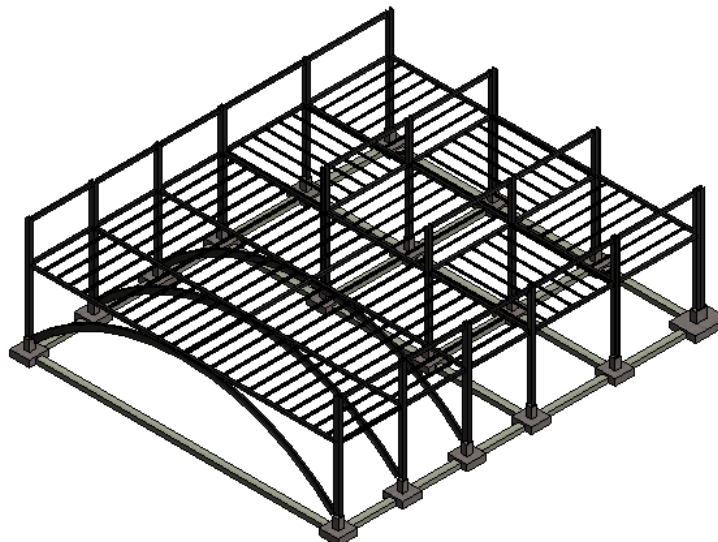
Estructura del forjado de la primera planta. Fuente: elaboración propia.
